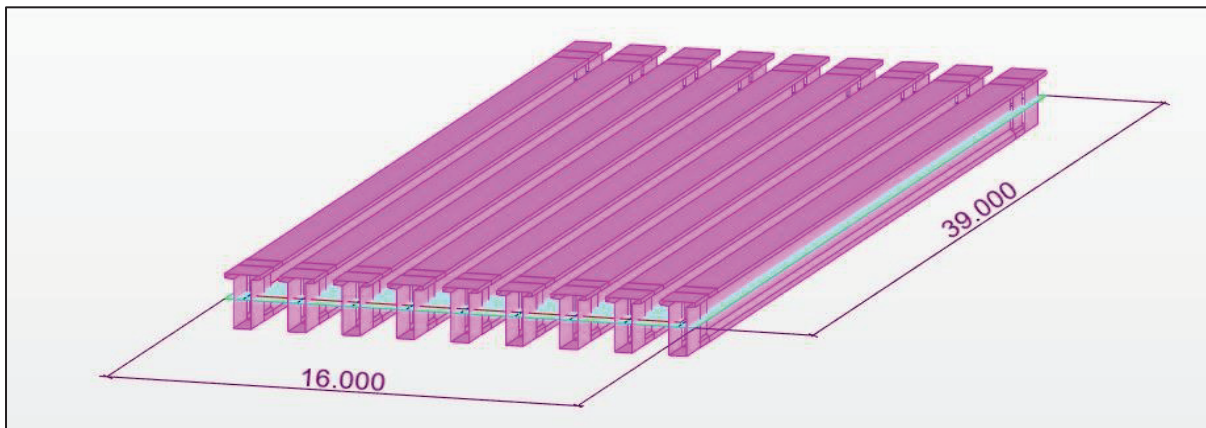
MODELE DE CALCUL PONT A POUTRE.
